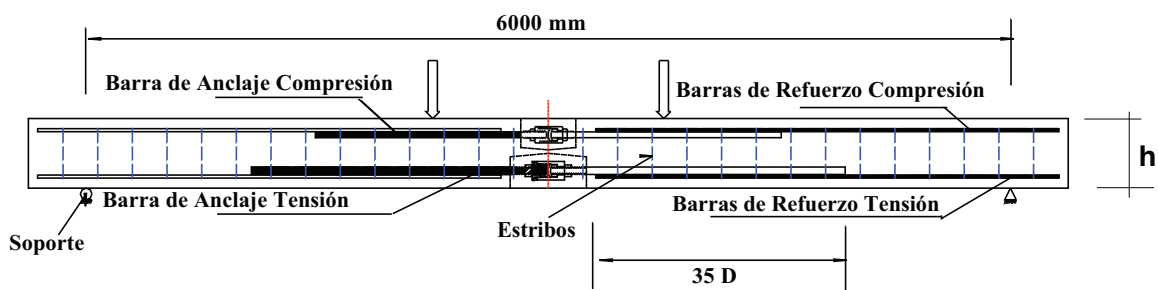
Vigas Pre-fabricada tipo: Sección Transversal.
